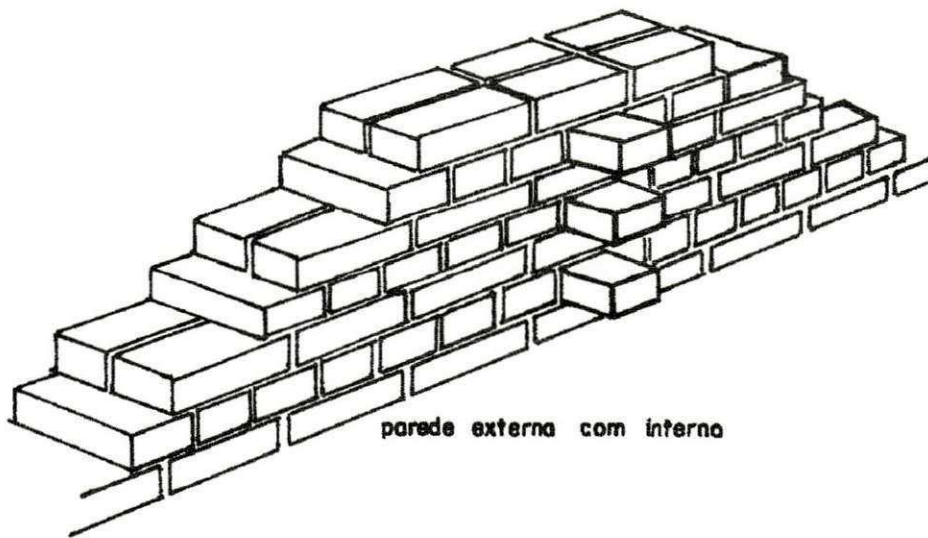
Canto em parede externa de um tijolo com parede interna de meio tijolo no ajuste francês
